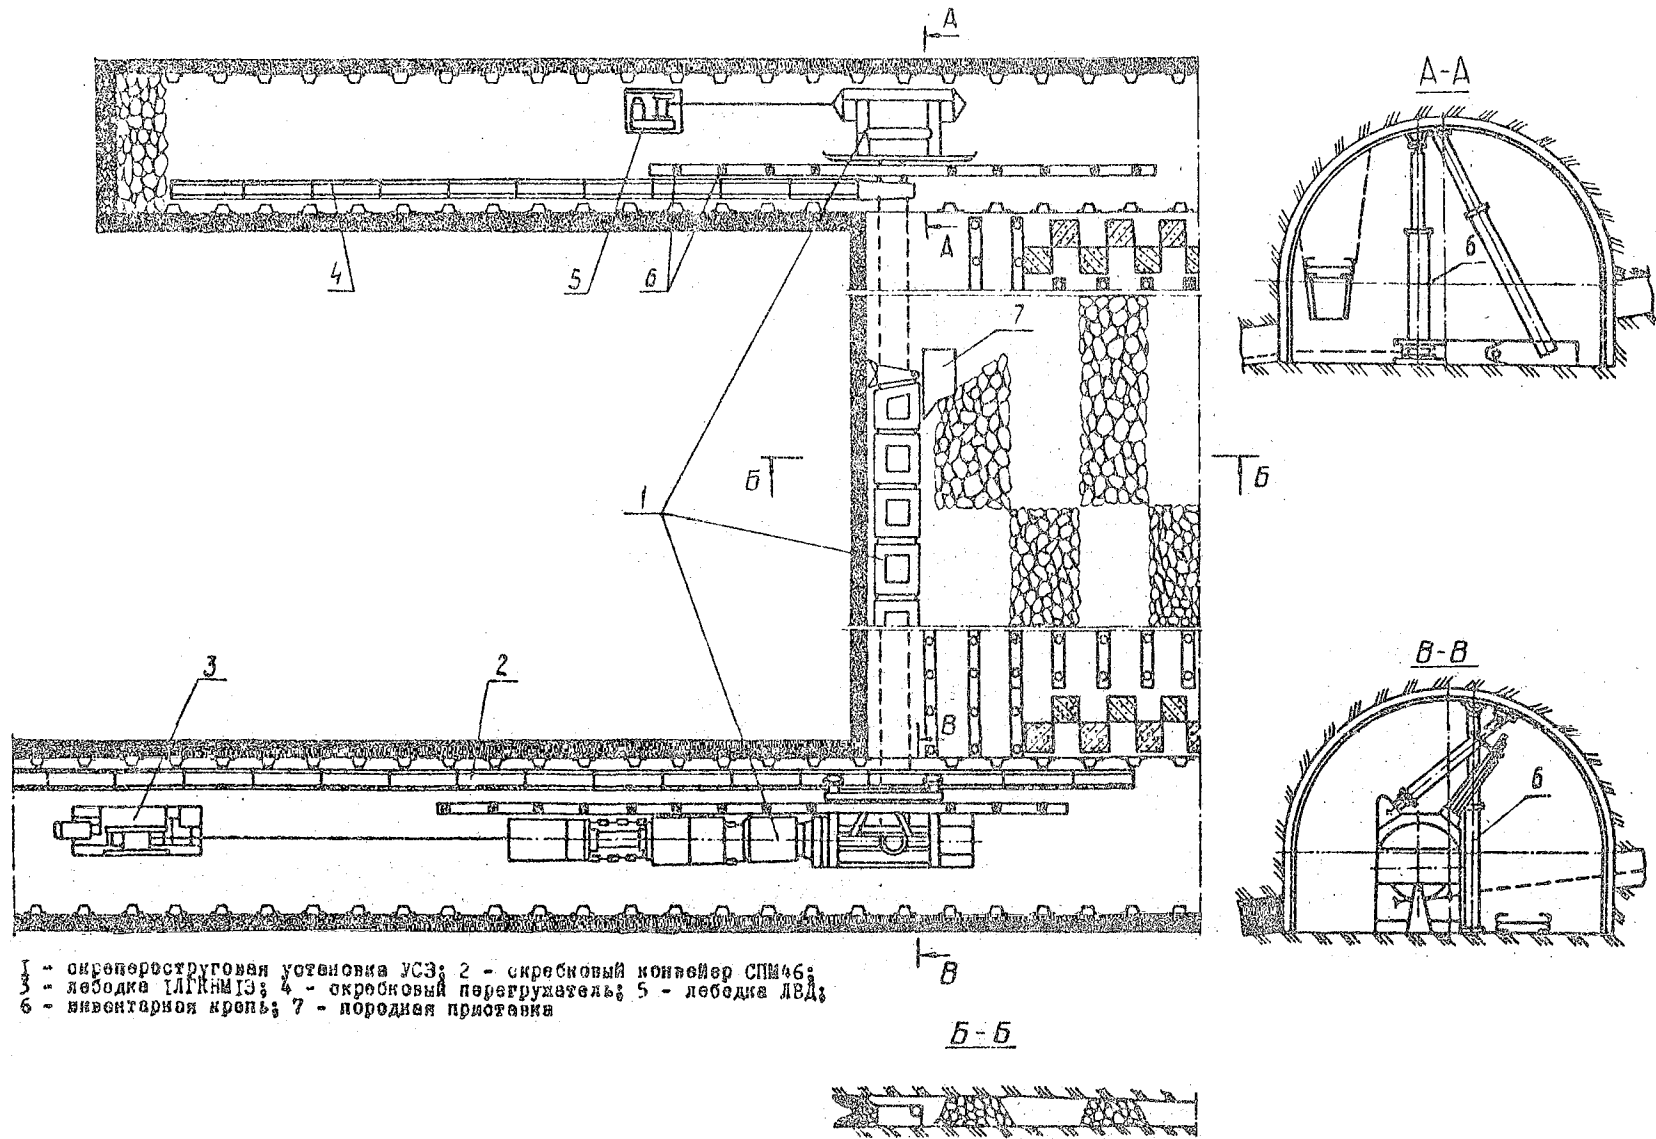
Схема безладной выемки скрепероструговой установкой с удержанием кровли на бутовых полосах.
